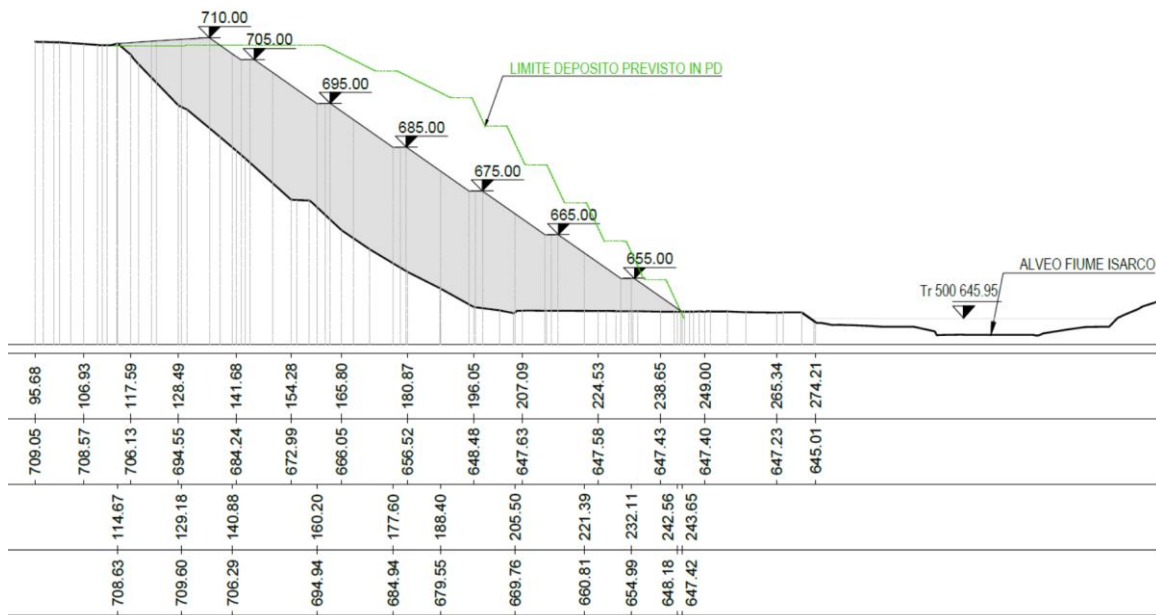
Sezione di raffronto fase finale PD – PE
